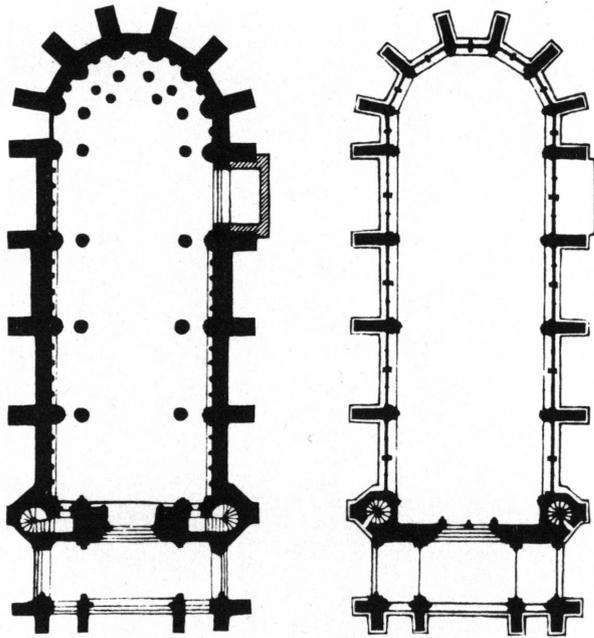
Sainte-Chapelle, plan de la chapelle haute.
